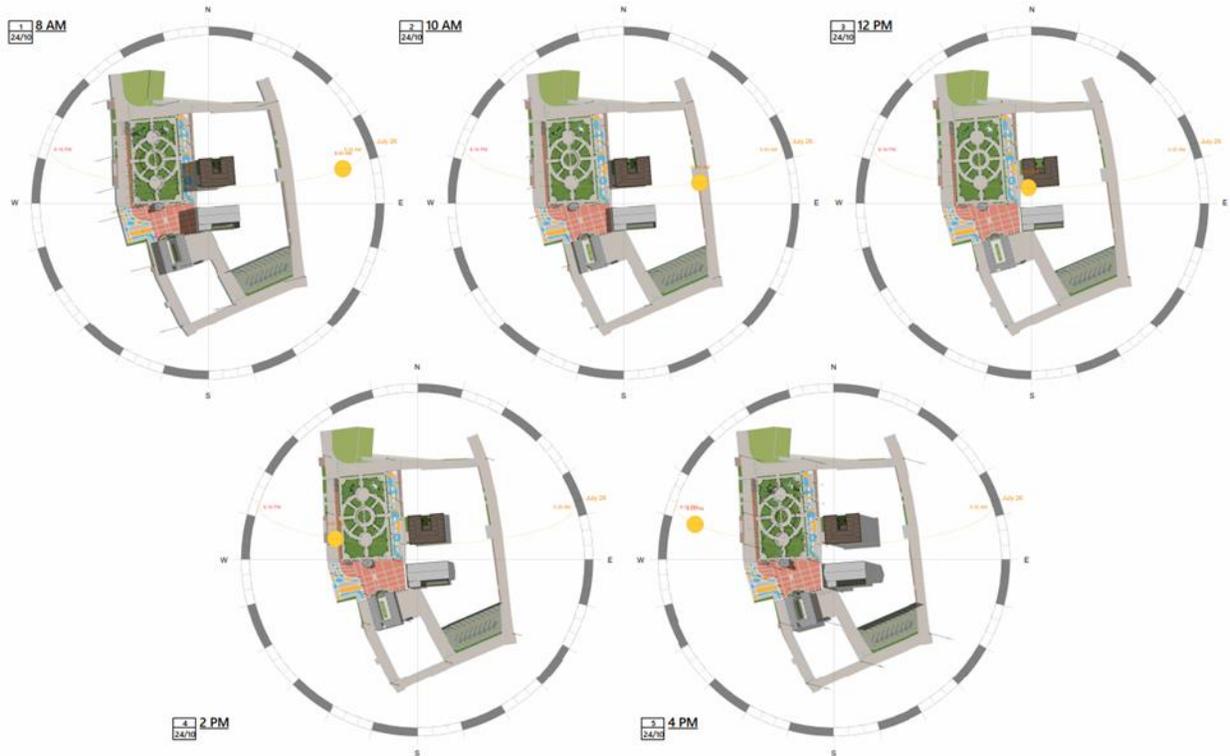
Asoleamiento del Barrio el Centro | Fuente: Elaboración Propia
